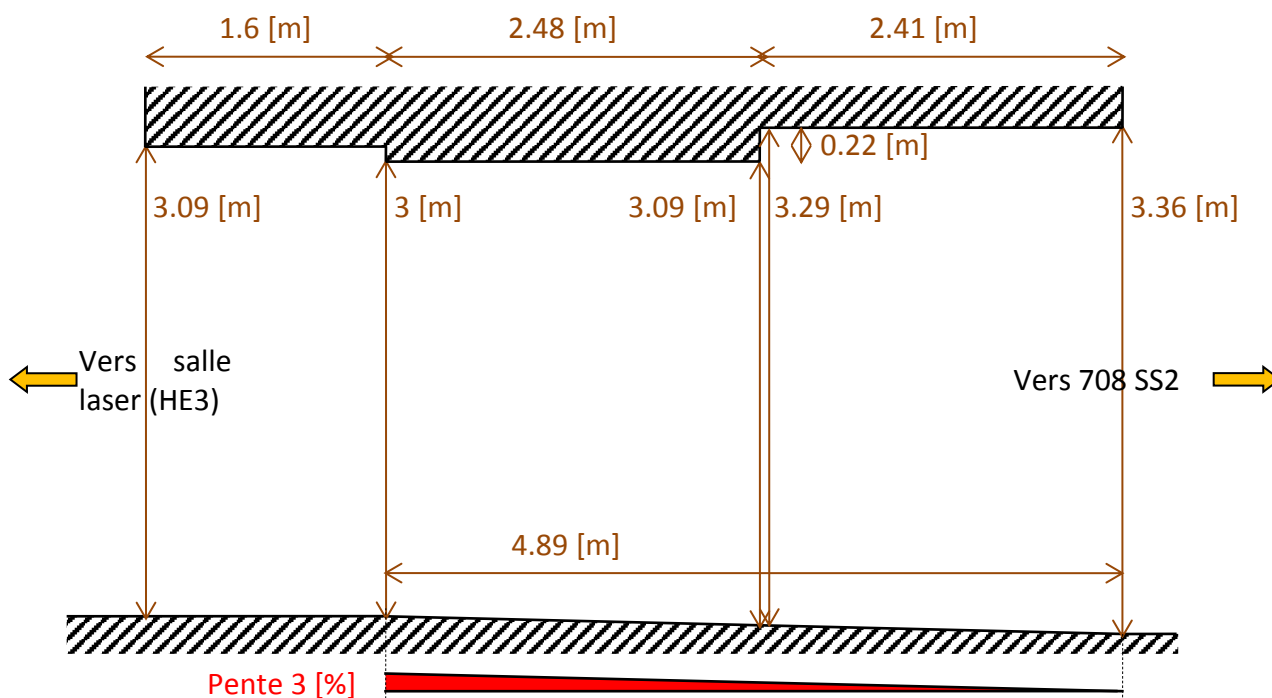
Vue en coupe (élévation) de la rampe d'accès vers la salle laser (HE3).
